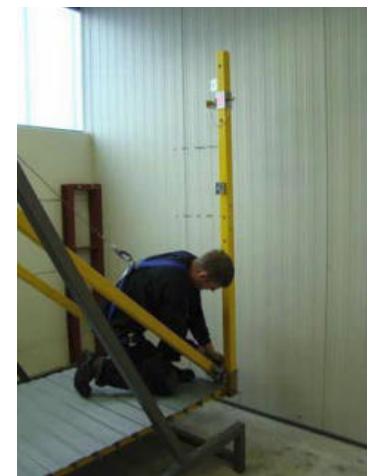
Bolzensicherung für die hintere senkrechte Geländerstütze
